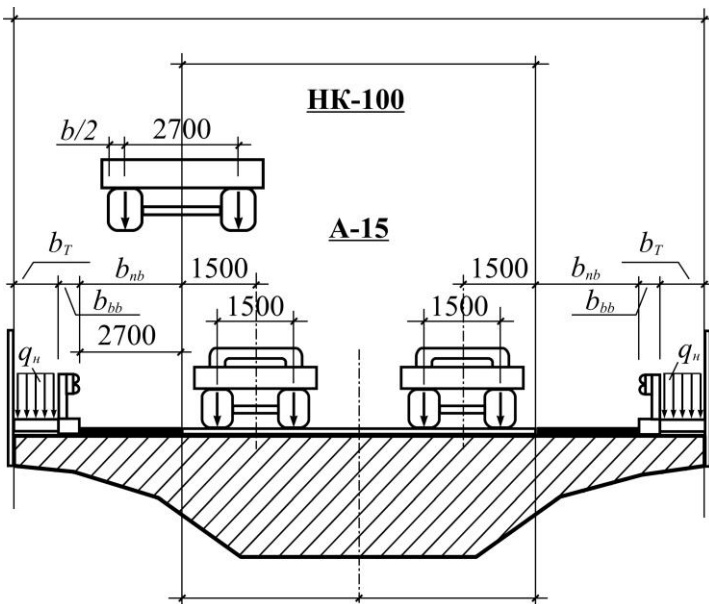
Перший випадок завантаження для А-15 або НК-100
